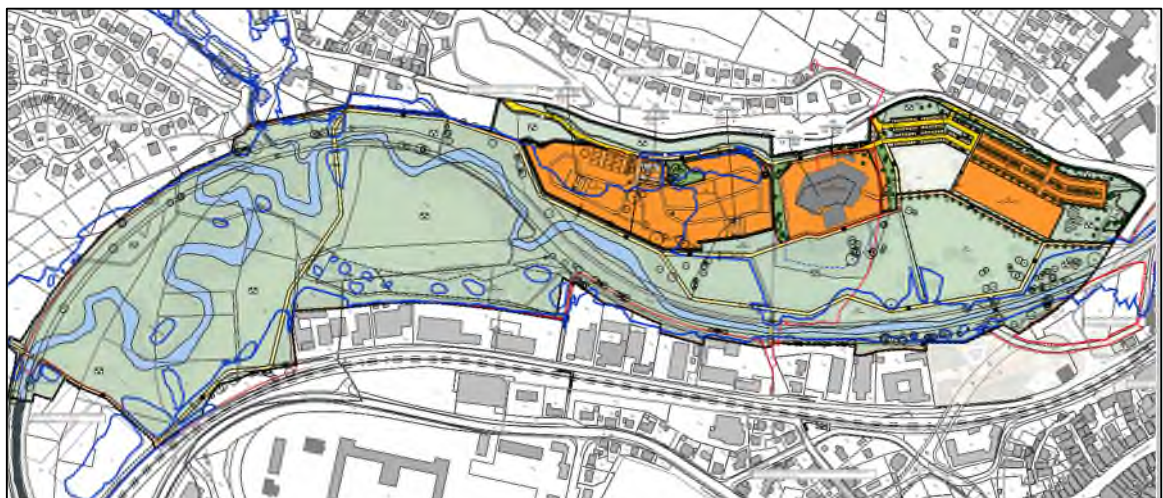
Bebauungsplan 'Landesgartenschau', Stand: 13.03.2023 [14]
